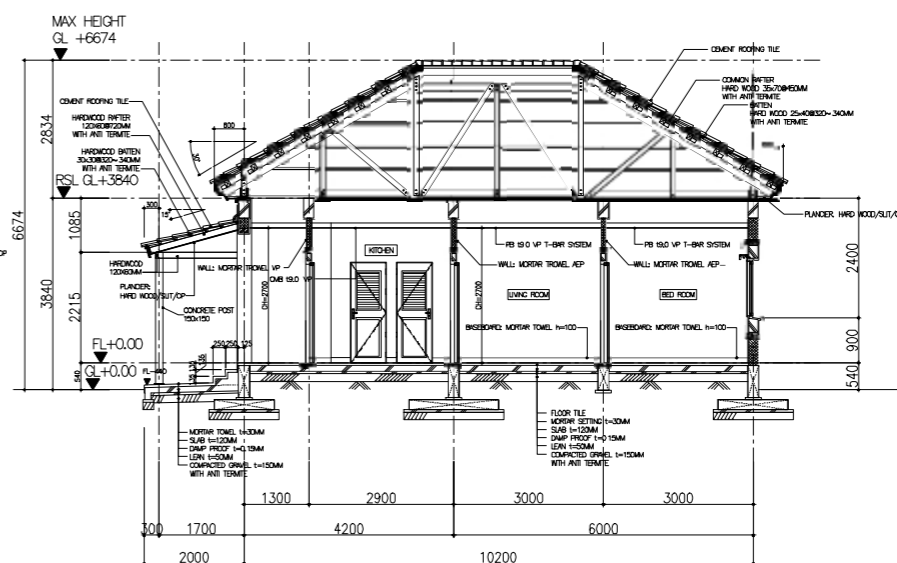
A-03 保健センター (タイプ B') の平面図、立面図、断面図
